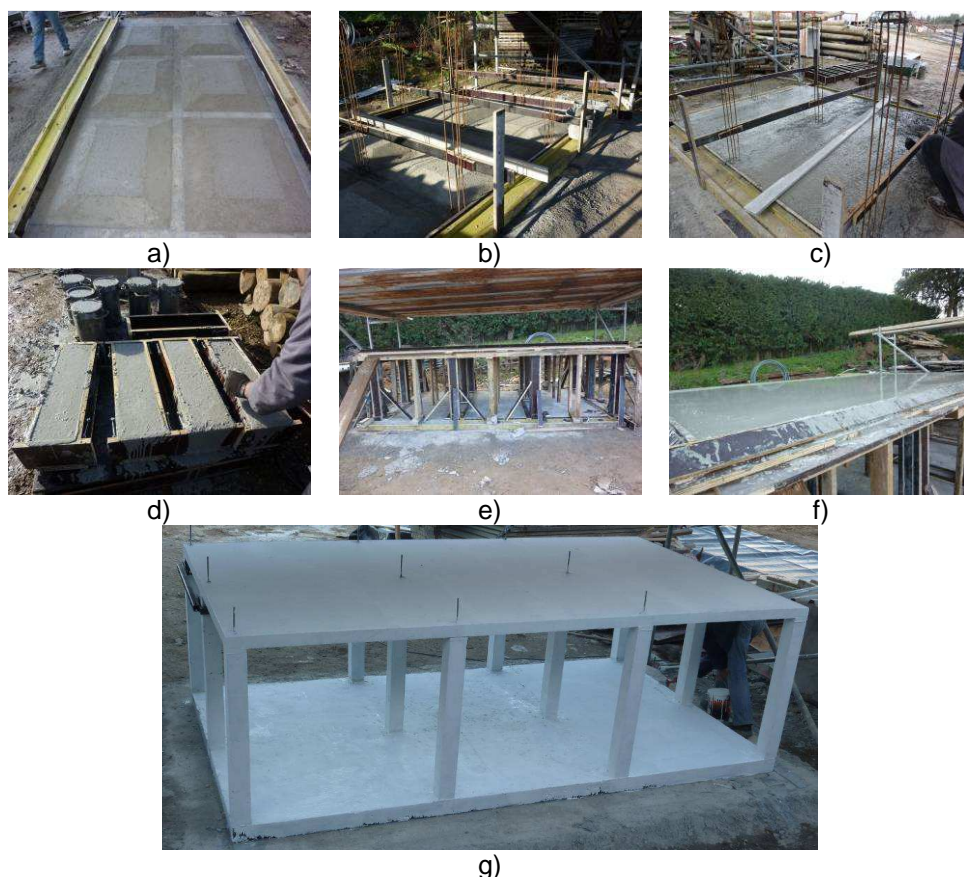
Construção do protótipo: a) Preparação da fundação para a laje de BACRFA apoiada em solo; b) Armaduras dos pilares; c) betonagem da laje apoiada em solo (1ª amassadura); d) Enchimentos dos provetes; e) Betonagem dos pilares (2ª amassadura); f) Betonagem da laje elevada; g) Aspetto final do protótipo após ter sido pintado.
